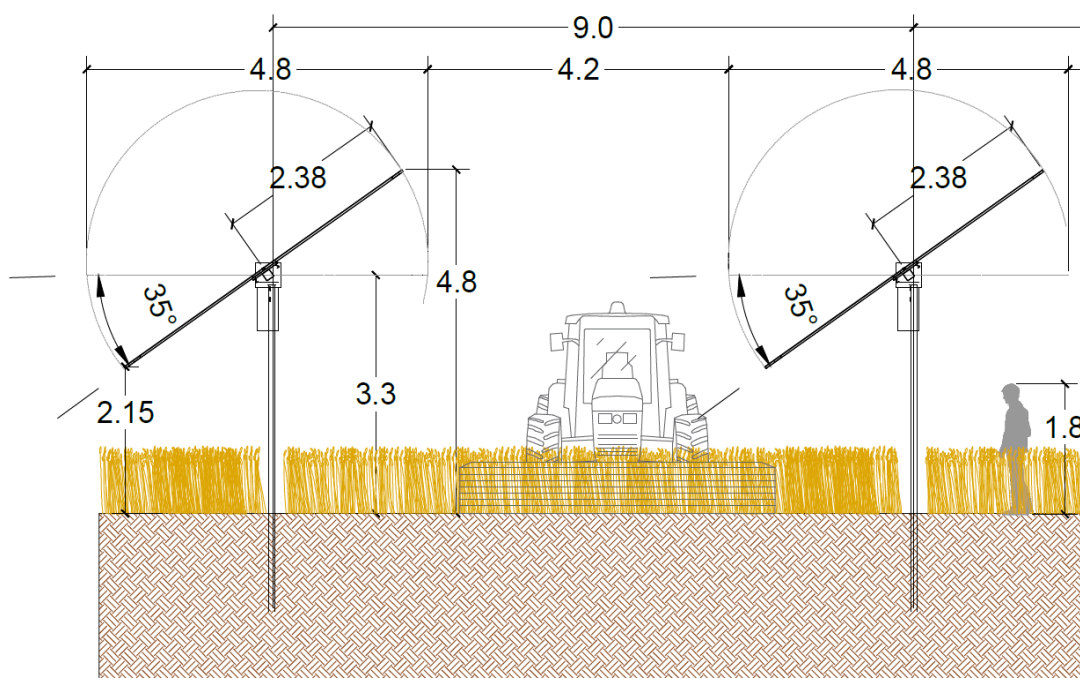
Particolare sezione struttura tracker inclinata a 35° - impianto standard
